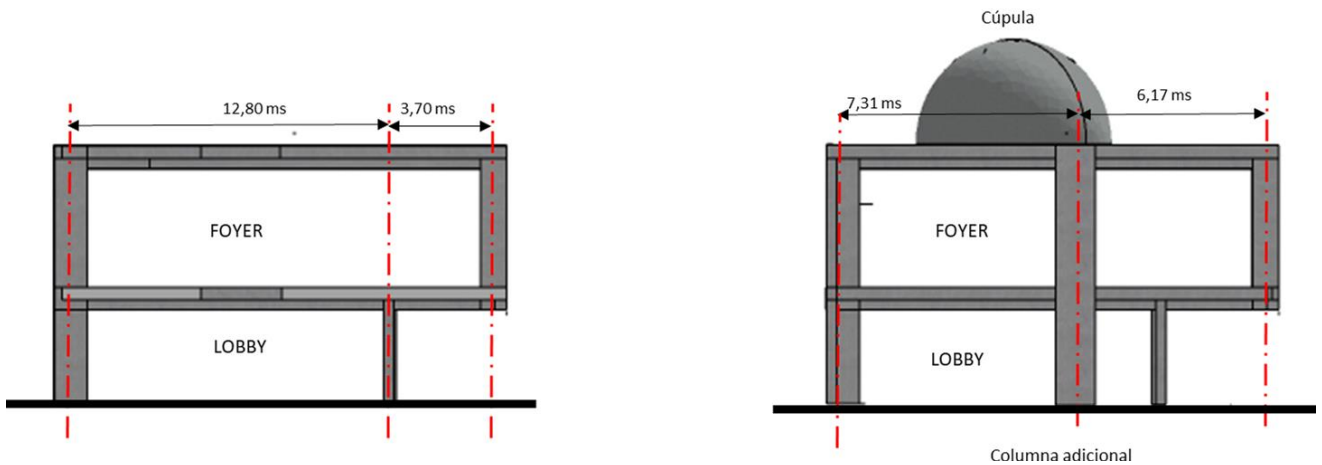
Columna de refuerzo en las vigas perimetrales del foyer construidas por Barón & Macchi en 1981.
